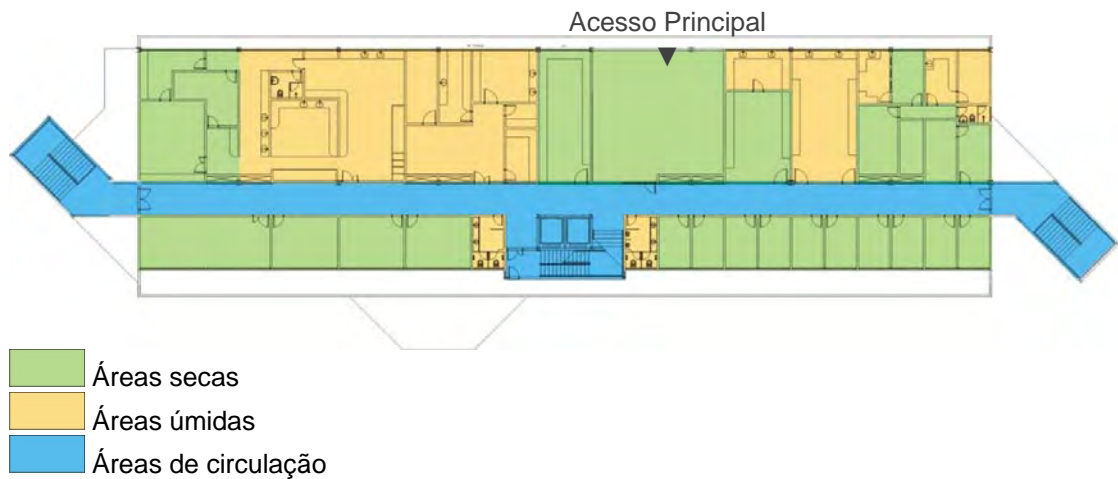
Planta tipo (esquemática do pavimento tipo) do CCB-II
